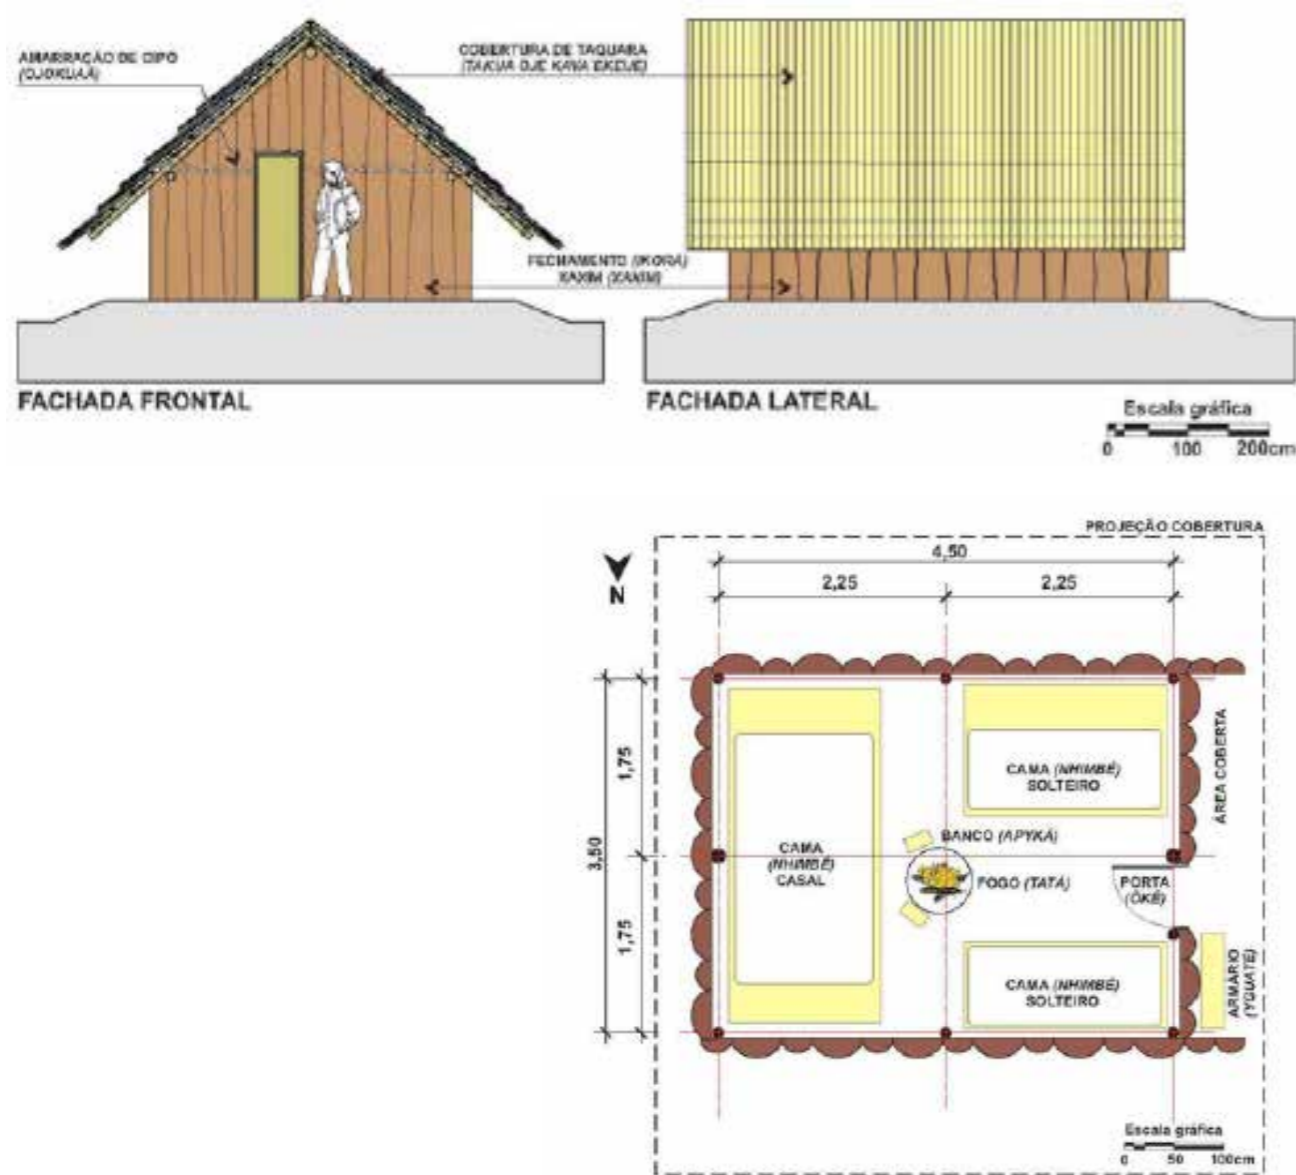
e 13 - Fachadas da tipologia de casa de Xaxim, e Planta Baixa da casa do Cacique. Fonte: Prudente (2007), p. 124.
